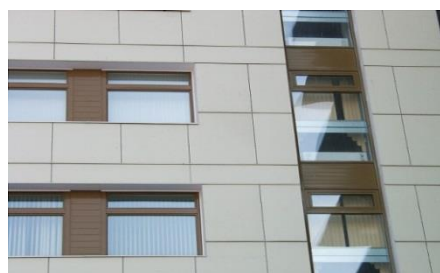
Улаштування системи утеплення на основі метода скріпленої теплоізоляції
